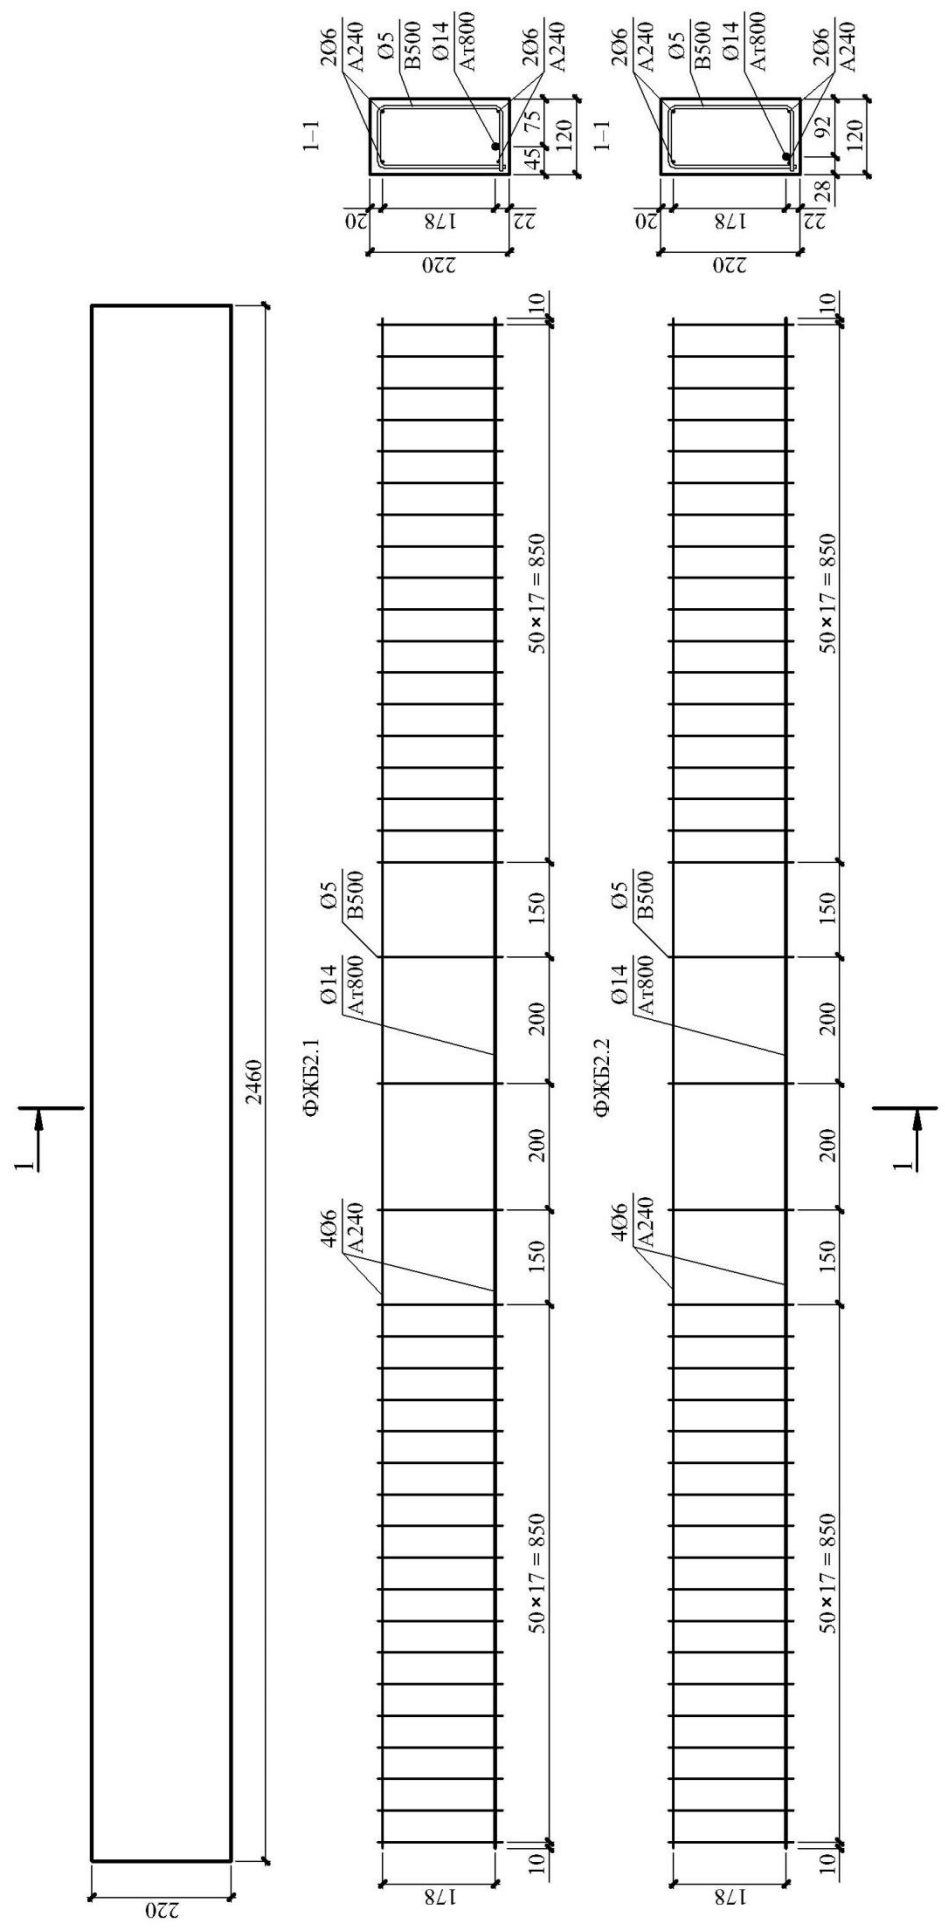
Схема армирования балок серий ФЖБ2.1 и ФЖБ2.2
